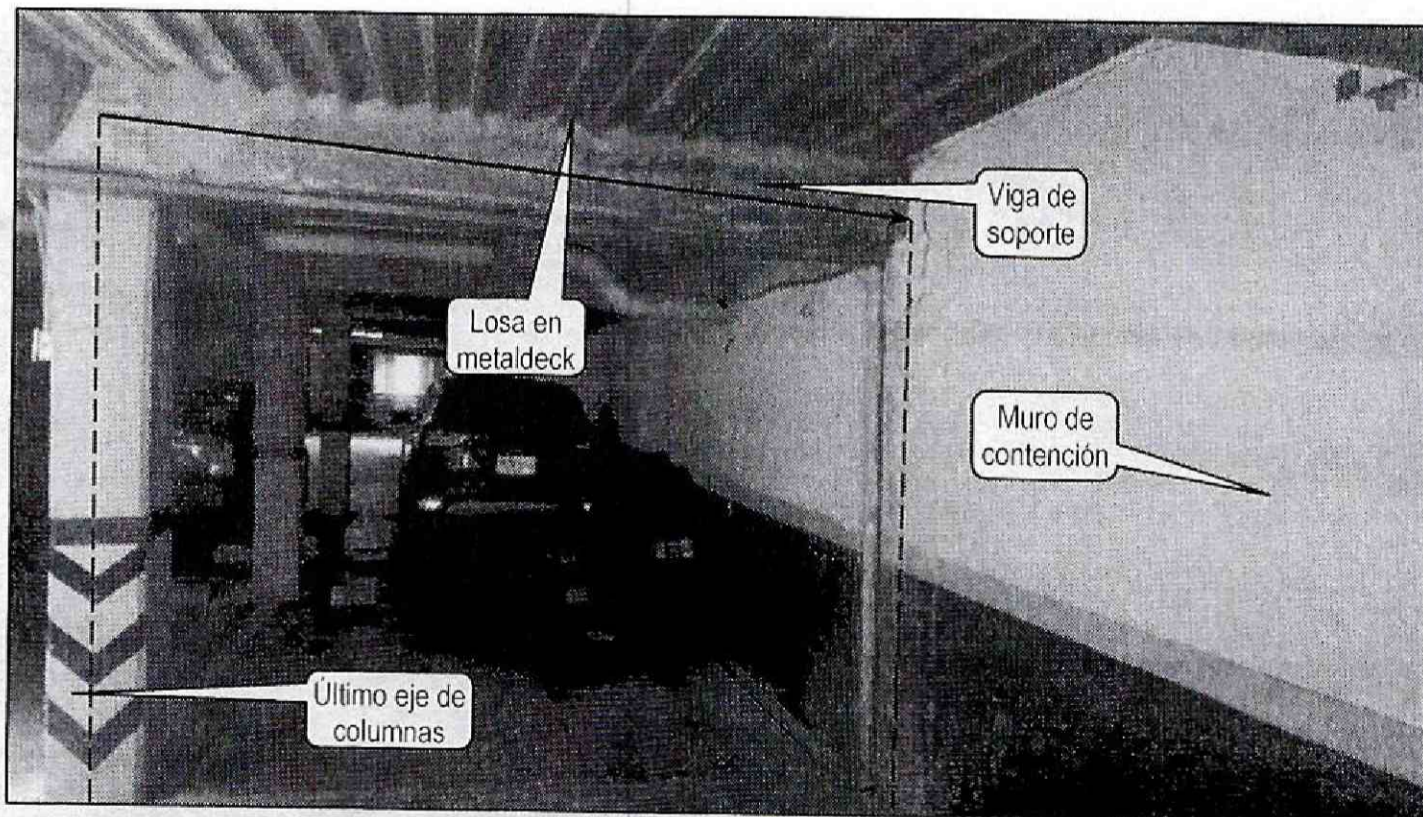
y 6. Vista de las grietas en el muro de contención de la Agrupación de Vivienda Takalí de Piedemonte P.H. emplazada en el predio de la Calle 167 No. 74-32, en el Barrio Casablanca de la Localidad de Suba
